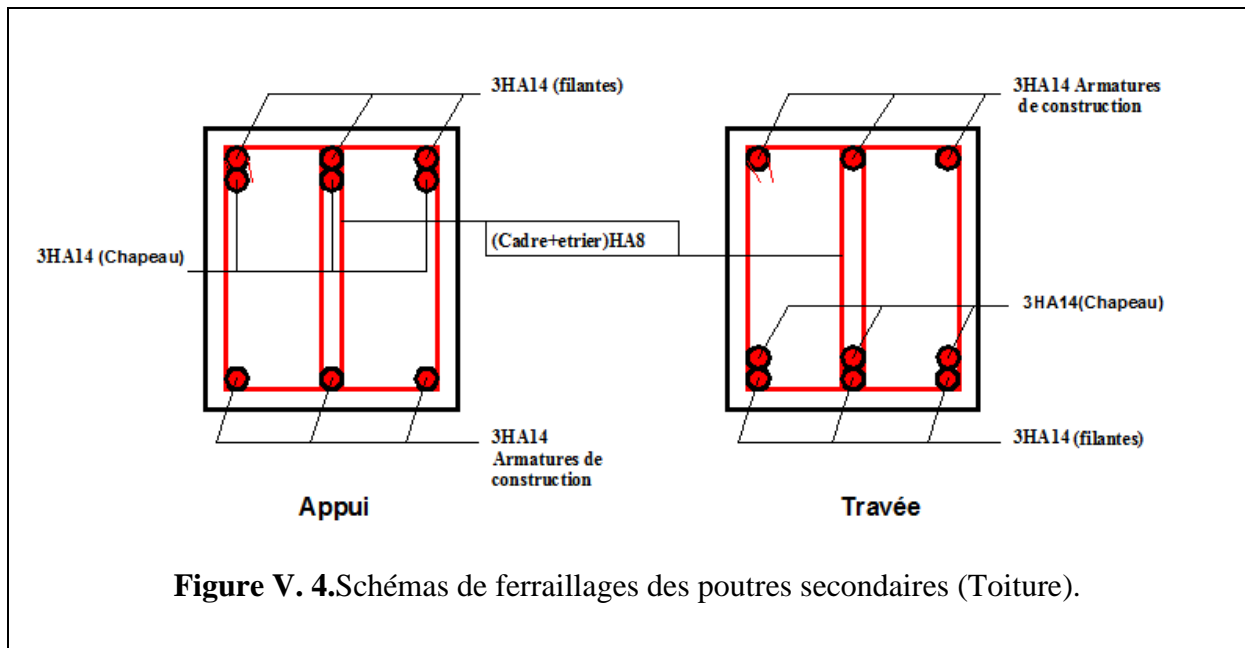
Schémas de ferrailages des poutres secondaires (Toiture).
